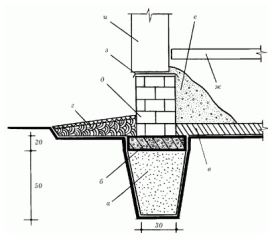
Устройство песчаного фундамента: а – крупнозернистый песок; б – бетон; в – уплотненный грунт; г – отмостка; д – цоколь; е – засыпка; ж – пол; з – гидроизоляция; и – стена.
